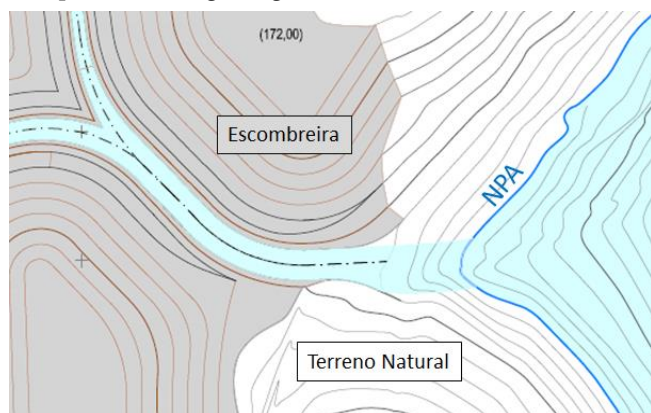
Planta da zona de restituição do escoamento à albufeira.
